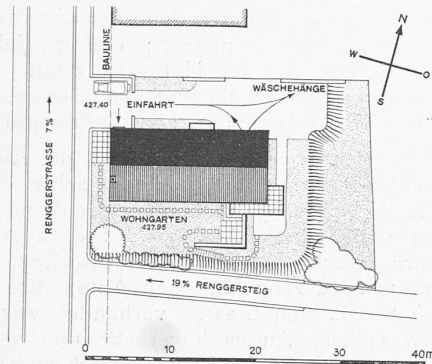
Lageplan des Arzthauses. — 1 : 800.
